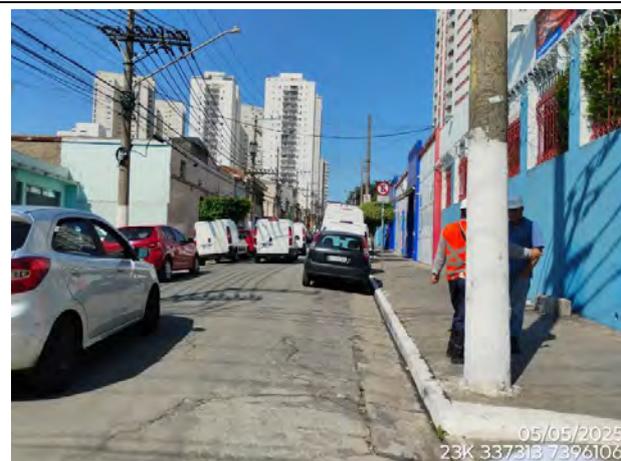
Vista geral da área de entrada do traçado da Linha de Distribuição Subterrânea Belém-Brás dentro da subestação Belém.
